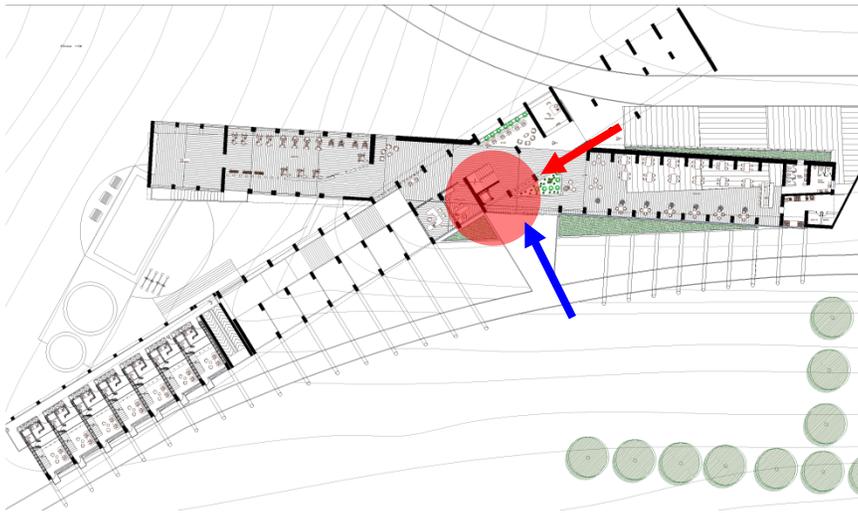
Planta funcionamiento primer nivel. (Flecha azul acceso peatonal – puente rojo vehicular y peatonal.)
